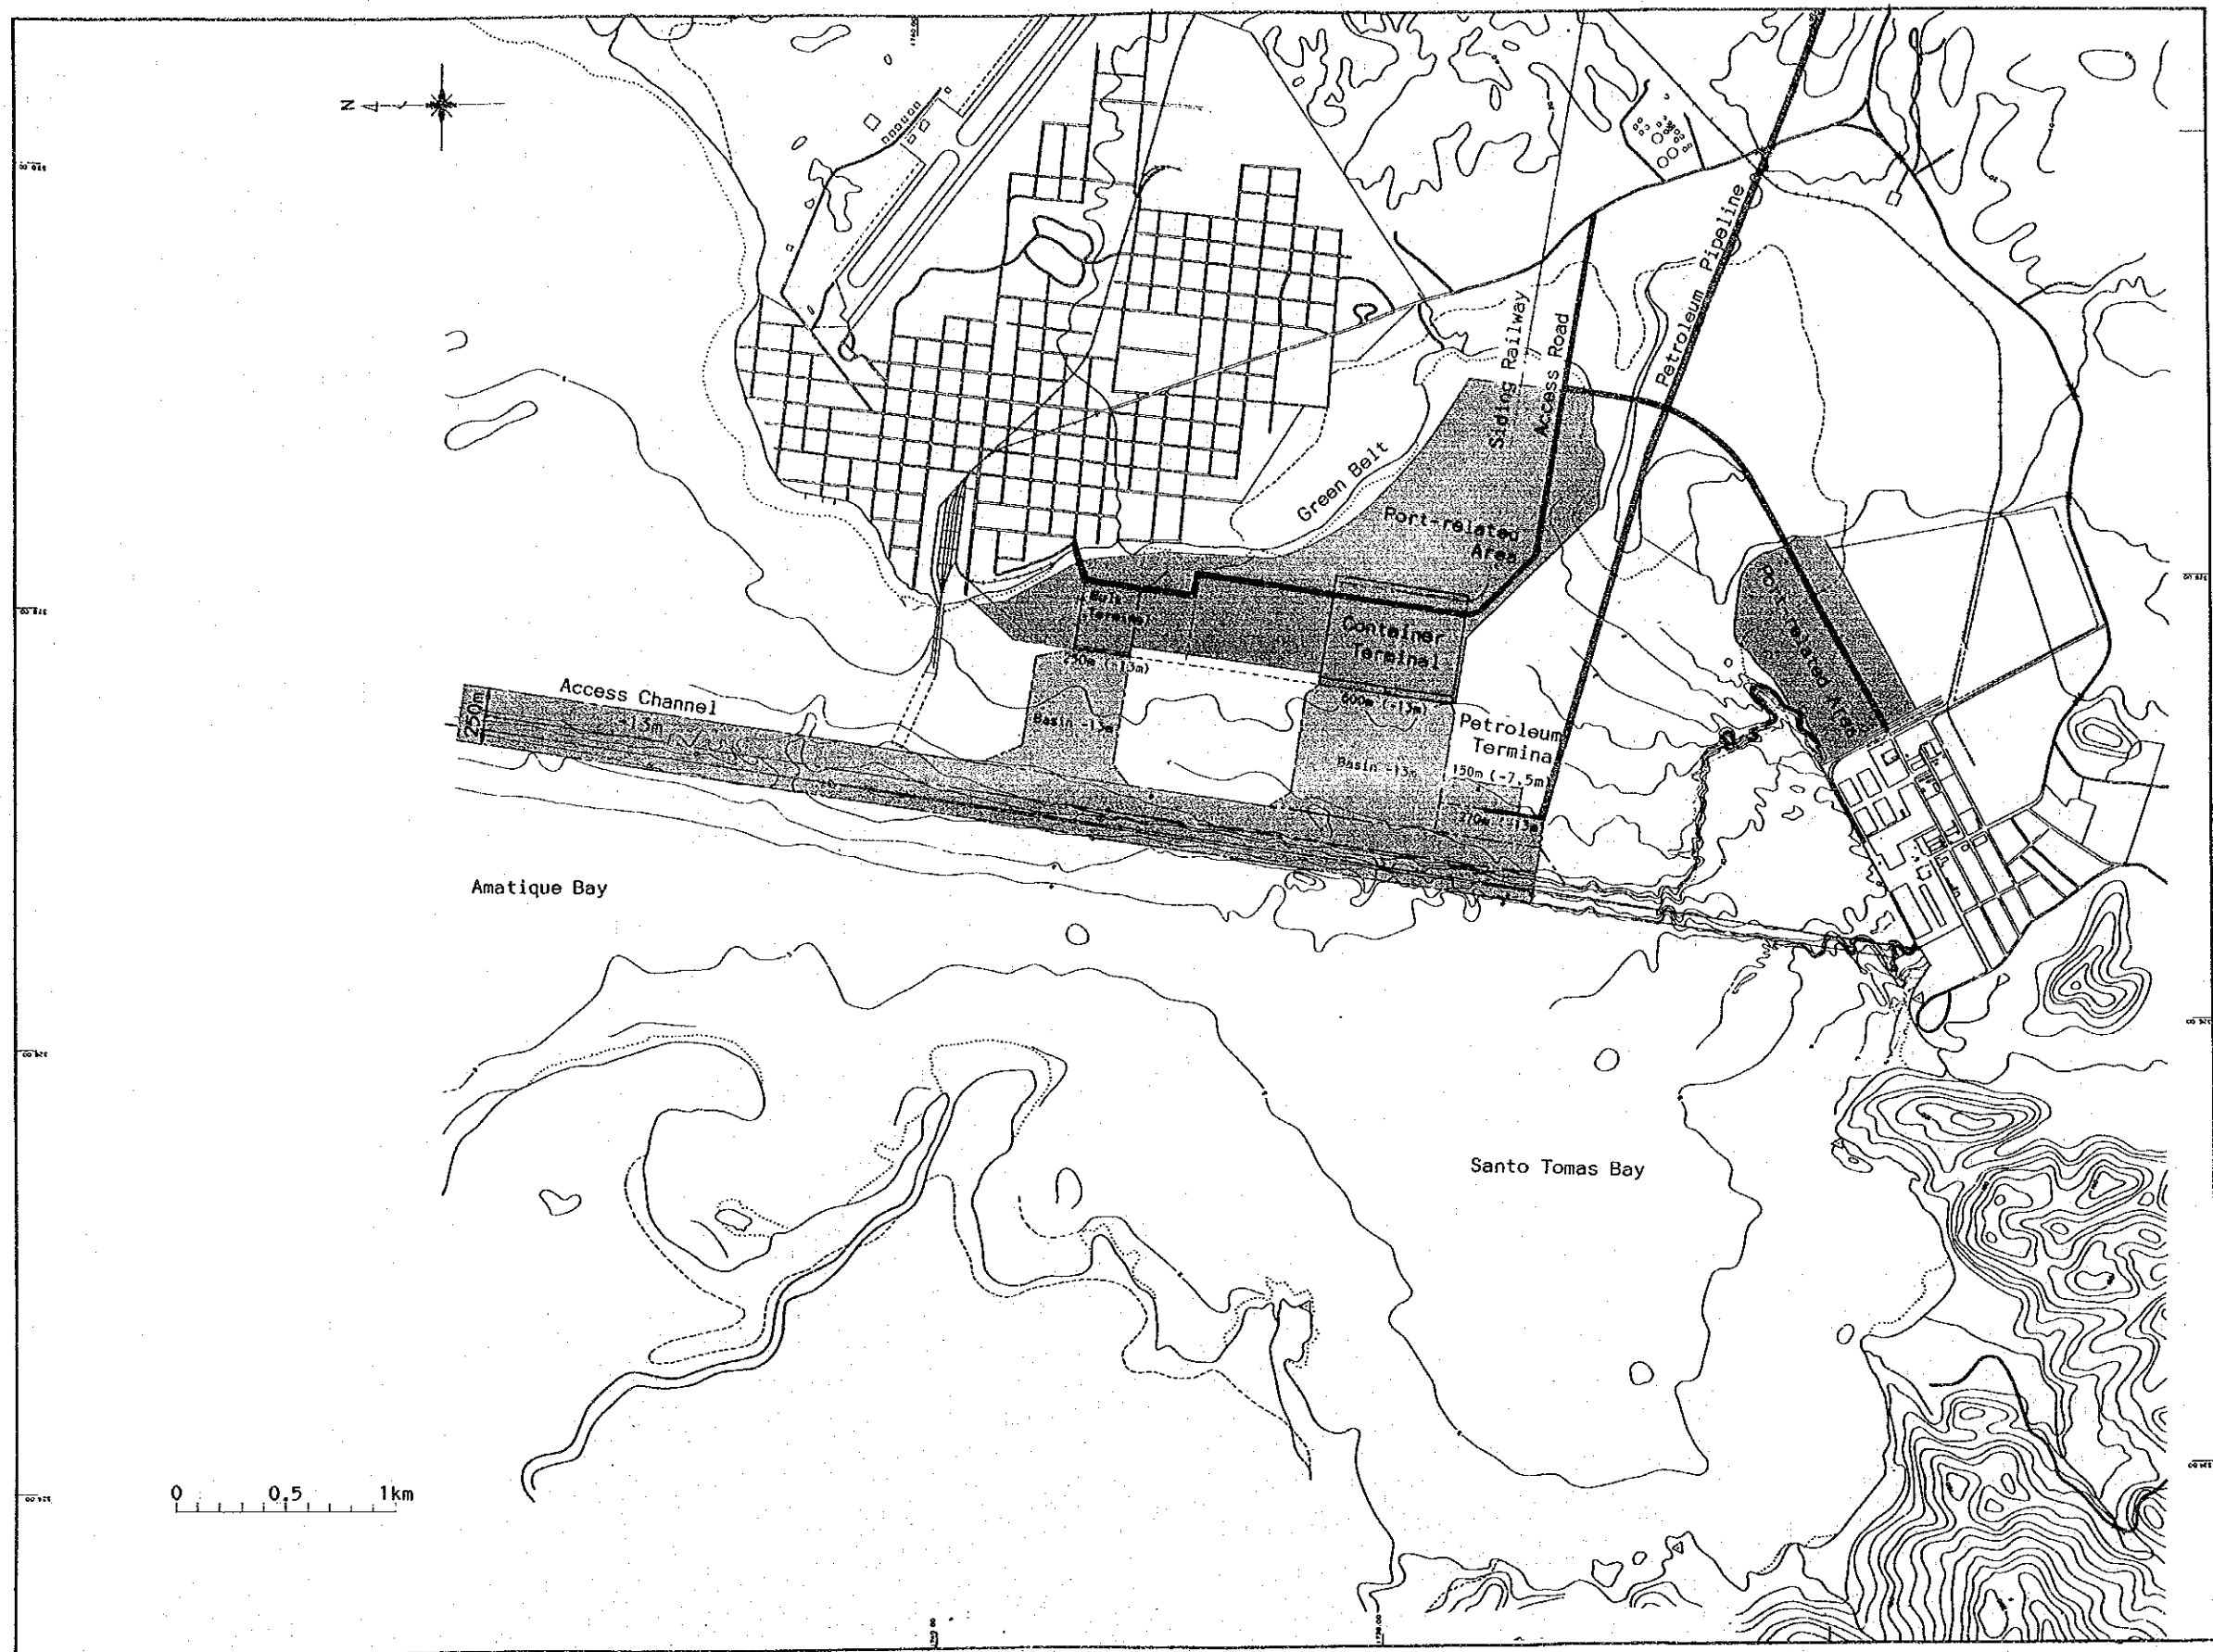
Plan Alternativo de Distribución ---Caso 3
